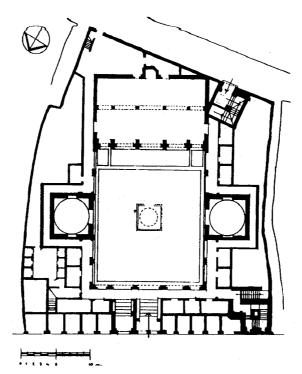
مسقط أفقي لجامع درغوت باشا بطرابلس الغرب بليبيا (عن موسوعة الآثار الاسلامية في ليبيا - ج١).
